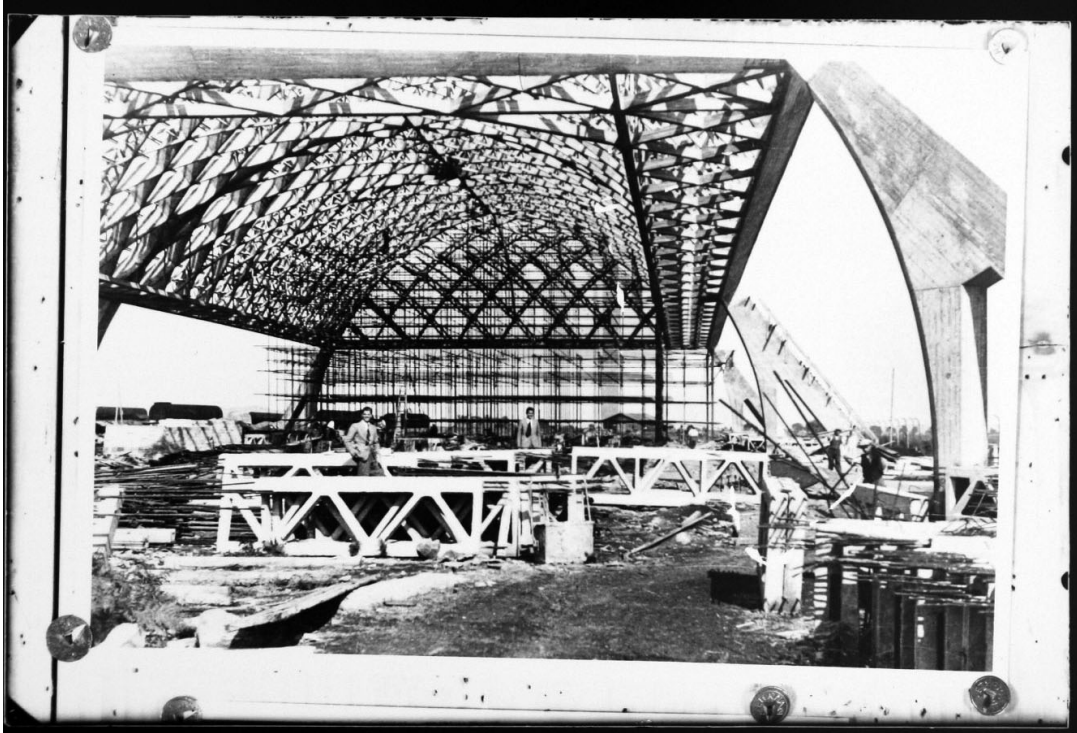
, Archivio Vasari, (Cantiere aviorimessa II tipo), 1939-42, CSAC, sezione fotografia.
